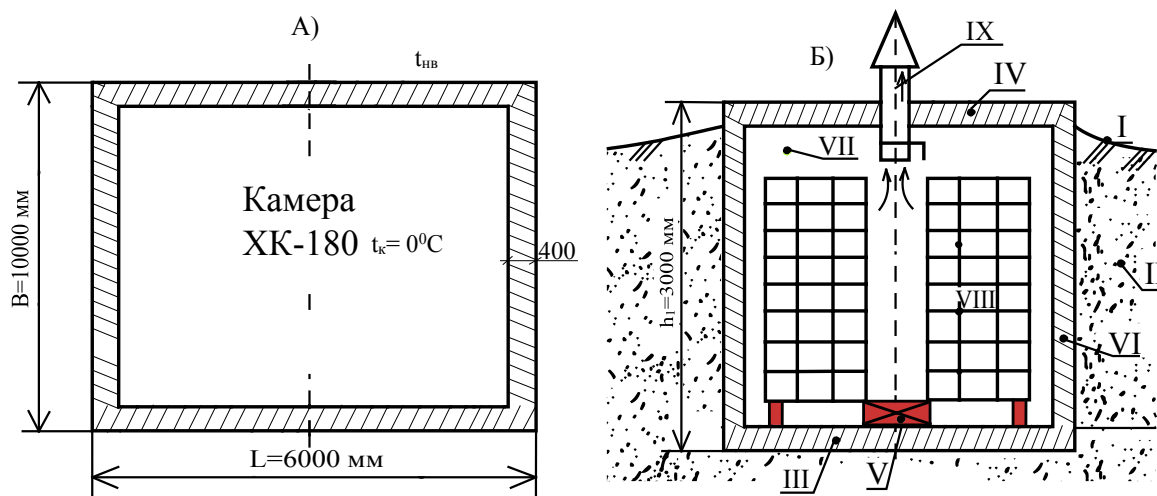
План (А) и поперечный разрез (Б) опытной углубленной плодовоощехранилища ХК – 180.
